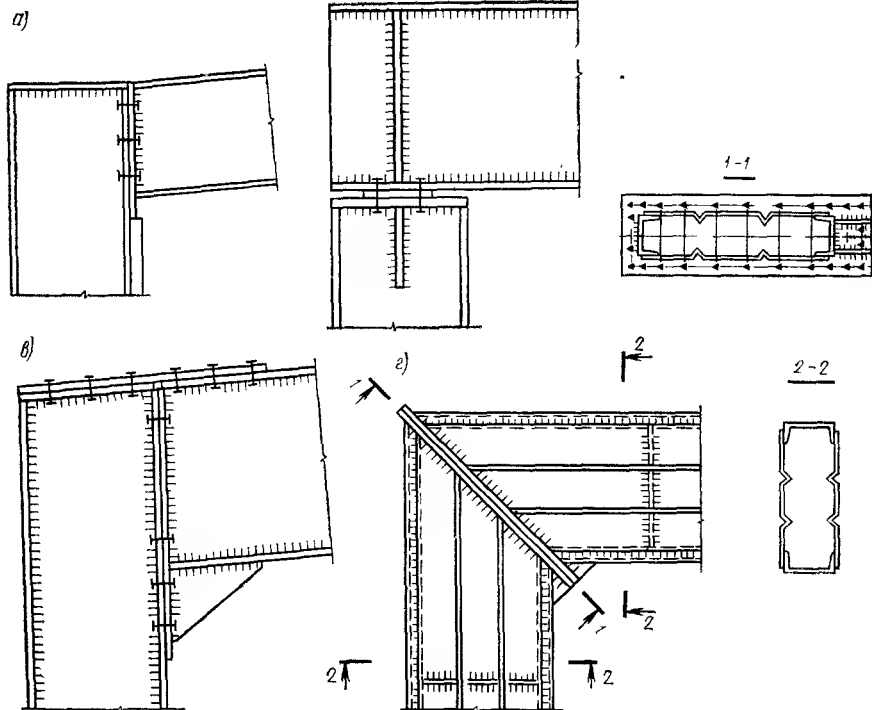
Примеры сопряжений стропильных конструкций сплошного сечения с колоннами
